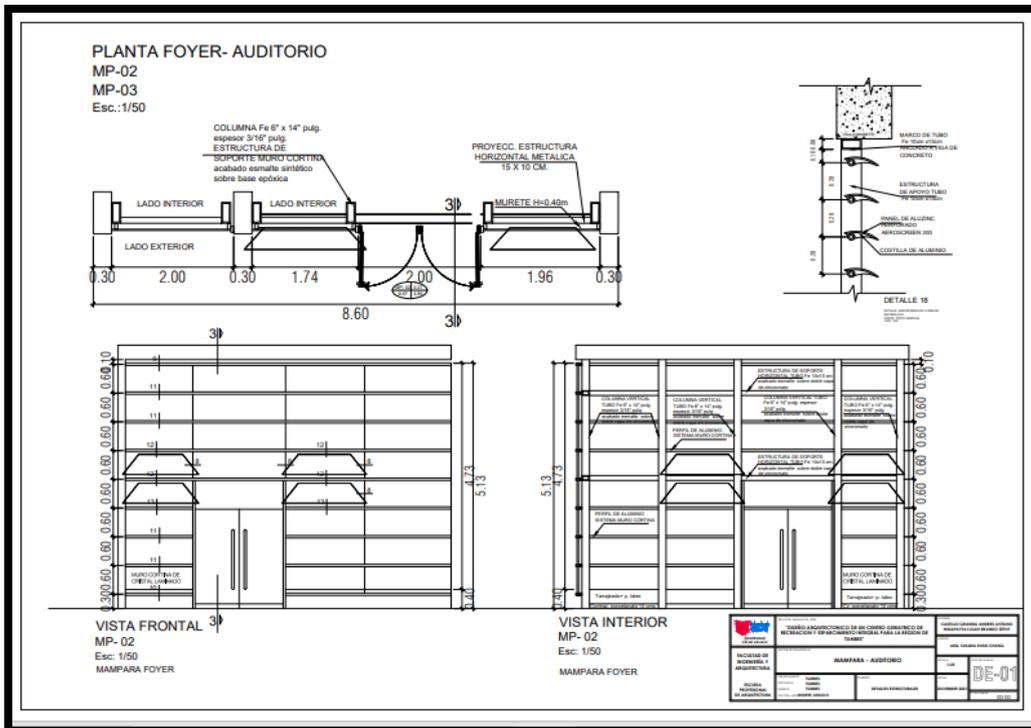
"Plano Detalles Estructurales"- Fuente: Elaboración Personal.
